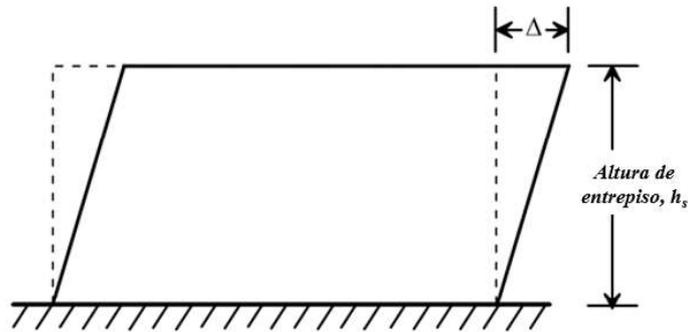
Distorsión de entrepiso en un muro estructural donde el cortante controla la respuesta inelástica
